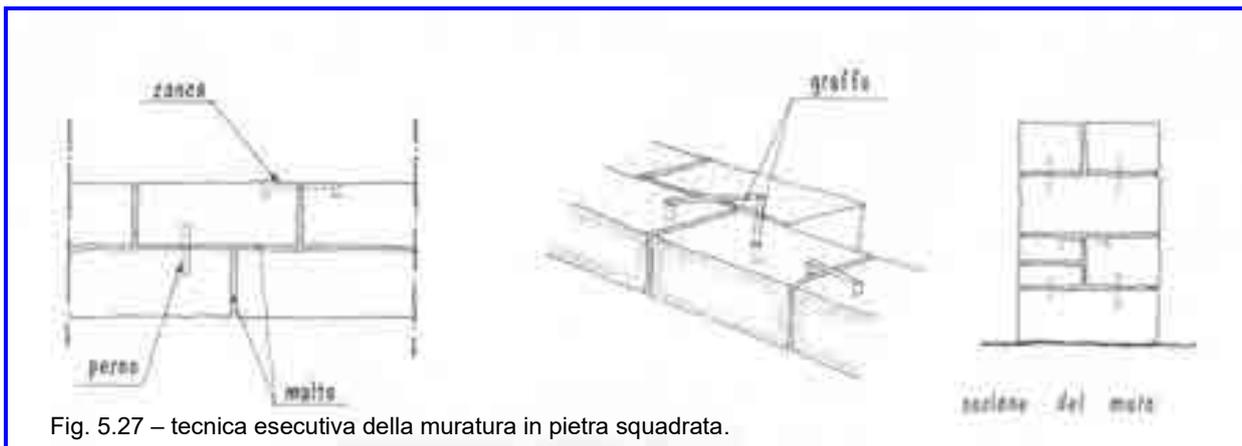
tecnica esecutiva della muratura in pietra squadrata.
